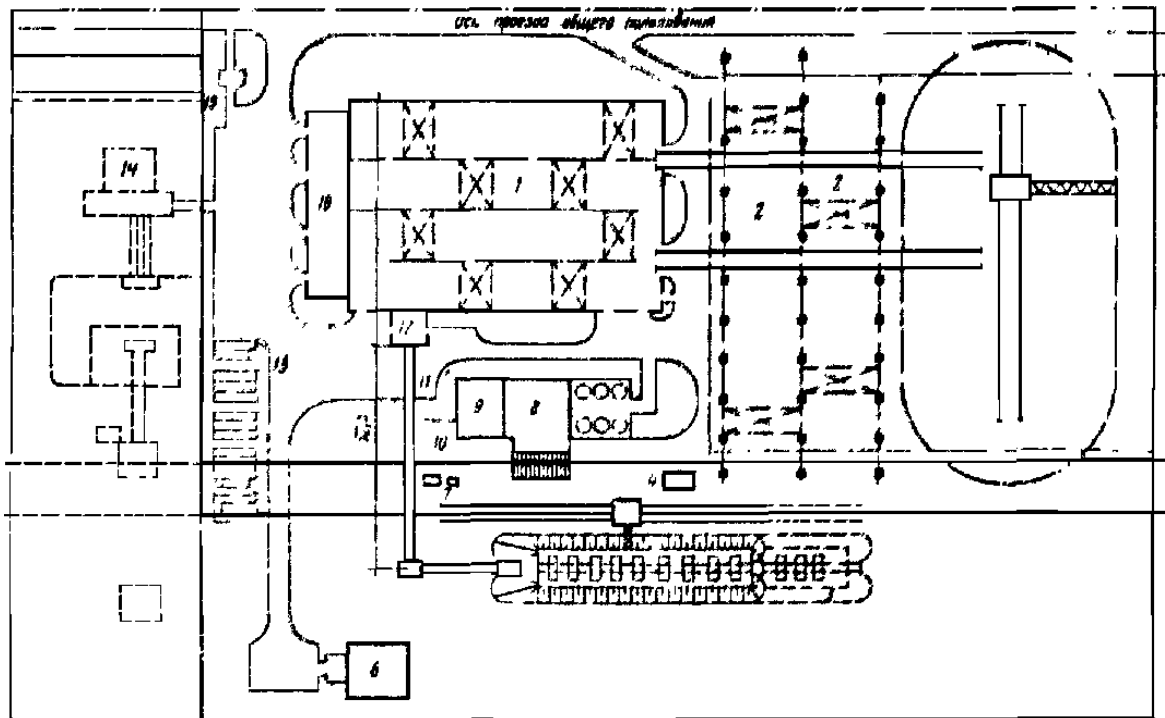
Генплан типового заводу залізобетонних конструкцій для водогосподарчого будівництва:
